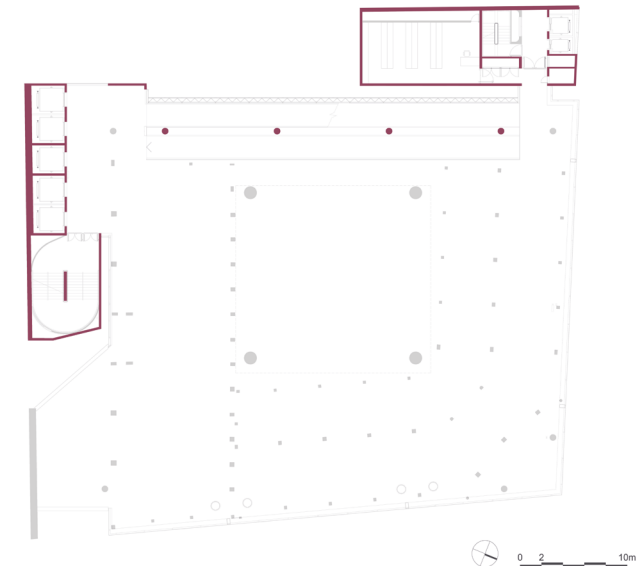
Elementos estructurales del conjunto 1. (Autoría propia, 2022).
